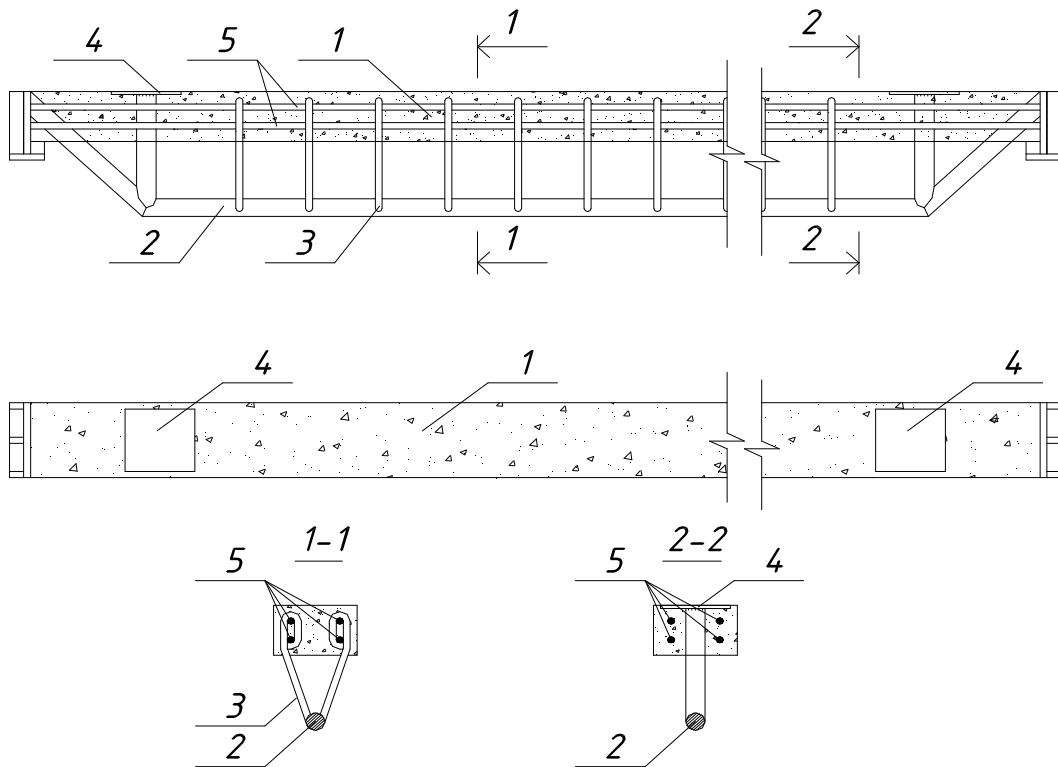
Залізобетонна балка з винесеним армуванням:
